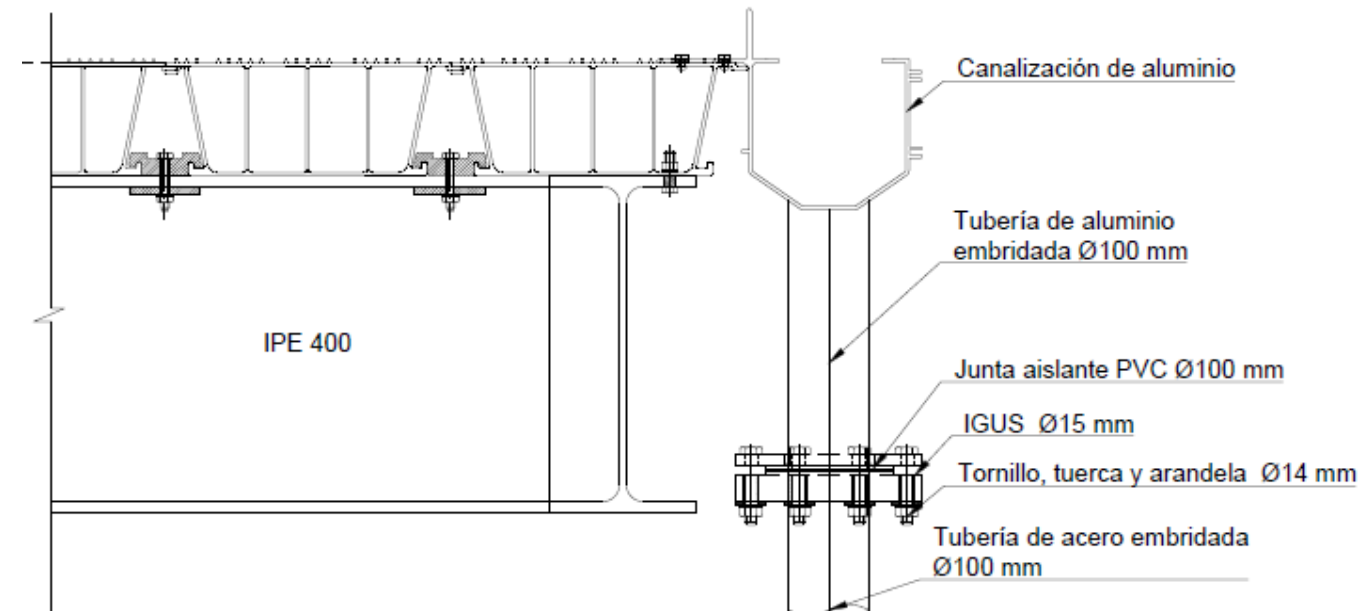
Unión sistema de drenaje con el tablero. Fuente: Propia.
